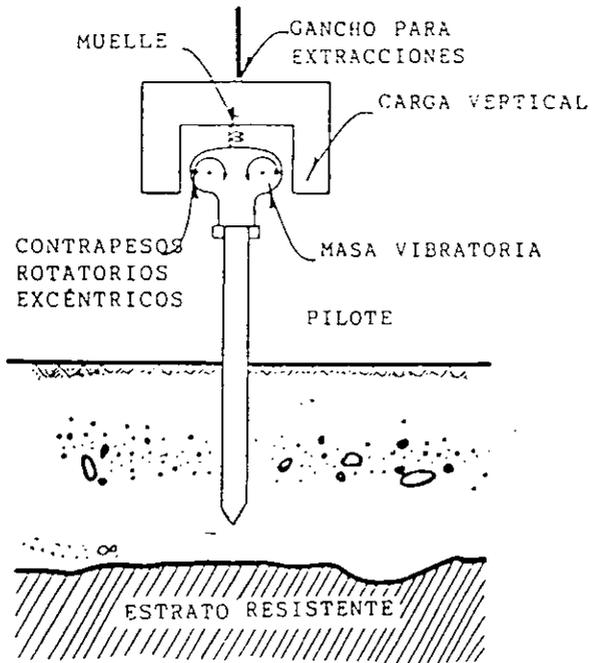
PILOTE HINCADO CON VIBRACIÓN.
